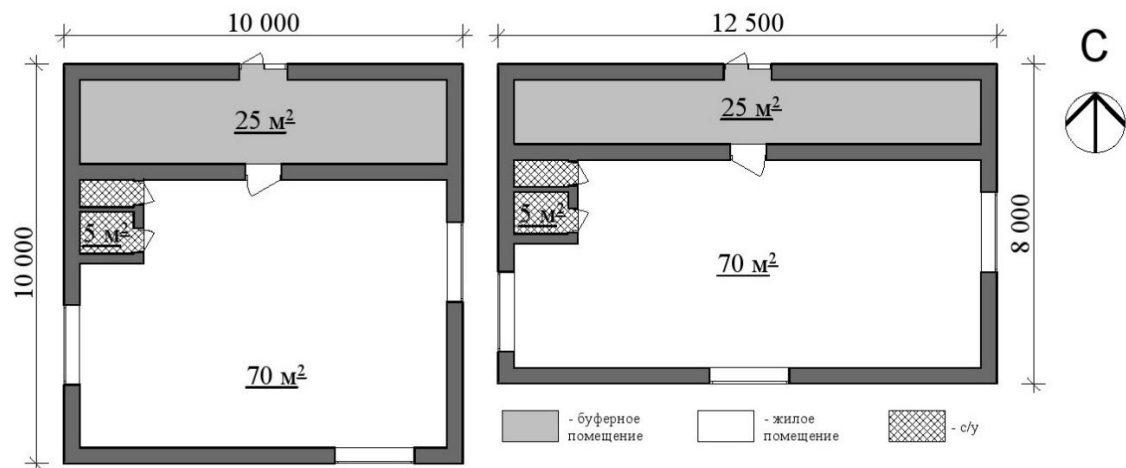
Планировка квадратного и прямоугольного зданий с выделением температурных зон
